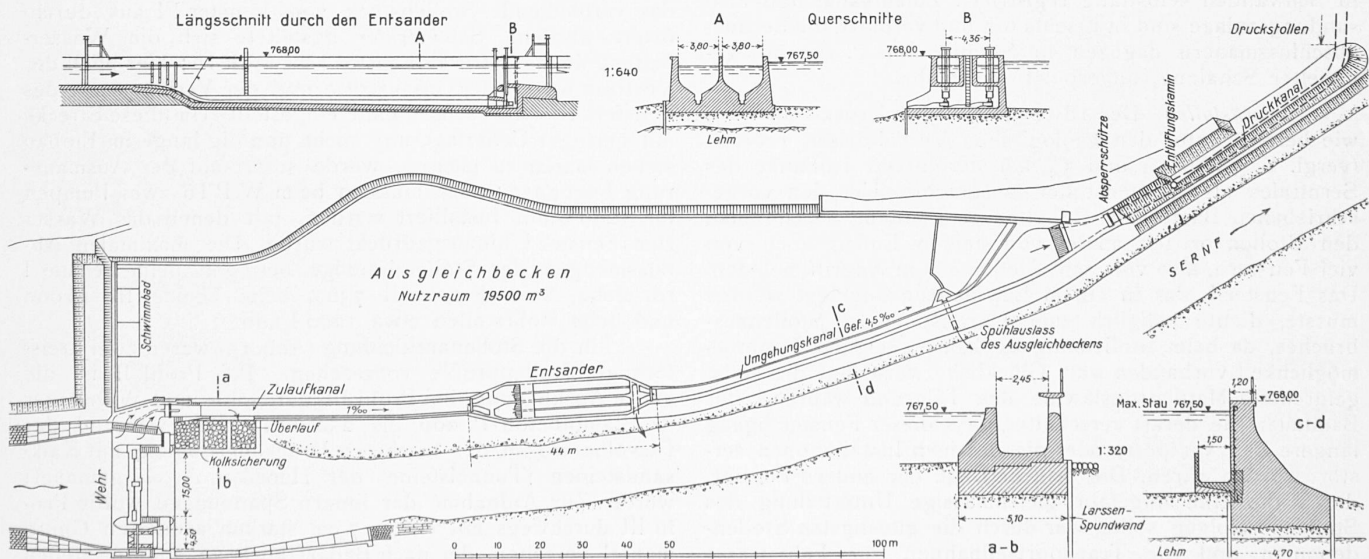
Lageplan (1:1600), sowie Schnitte von Wasserfassung, Ausgleichbecken, Dufour-Entsander und Stolleneinlauf („Druckkanal“).
